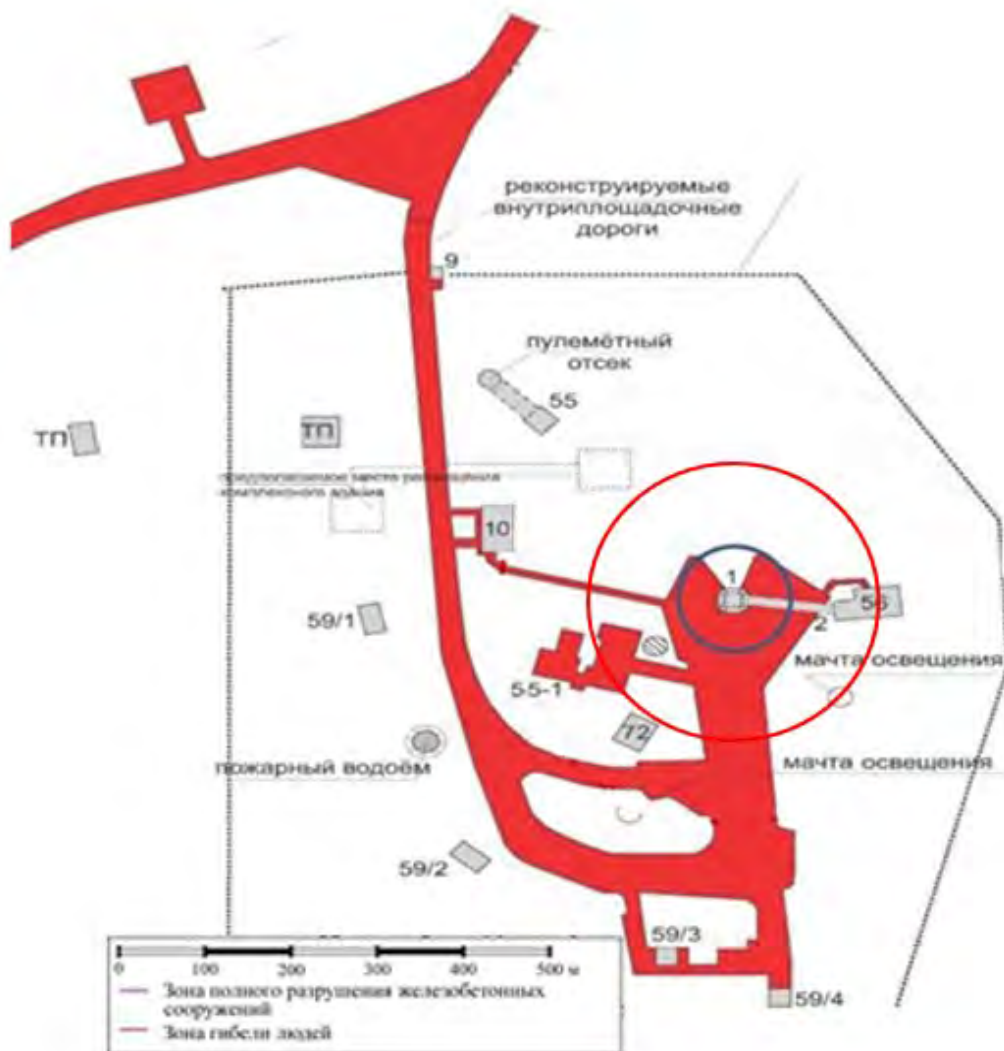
Зоны поражения человека и разрушения железобетонных конструкций при взрыве изделия в стартовой площадке
